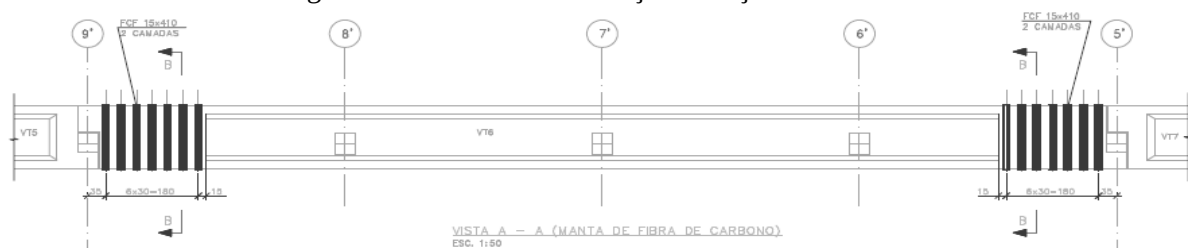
Detalhe armadura complementar nos apoios Figura 8 – Detalhe da armadura
